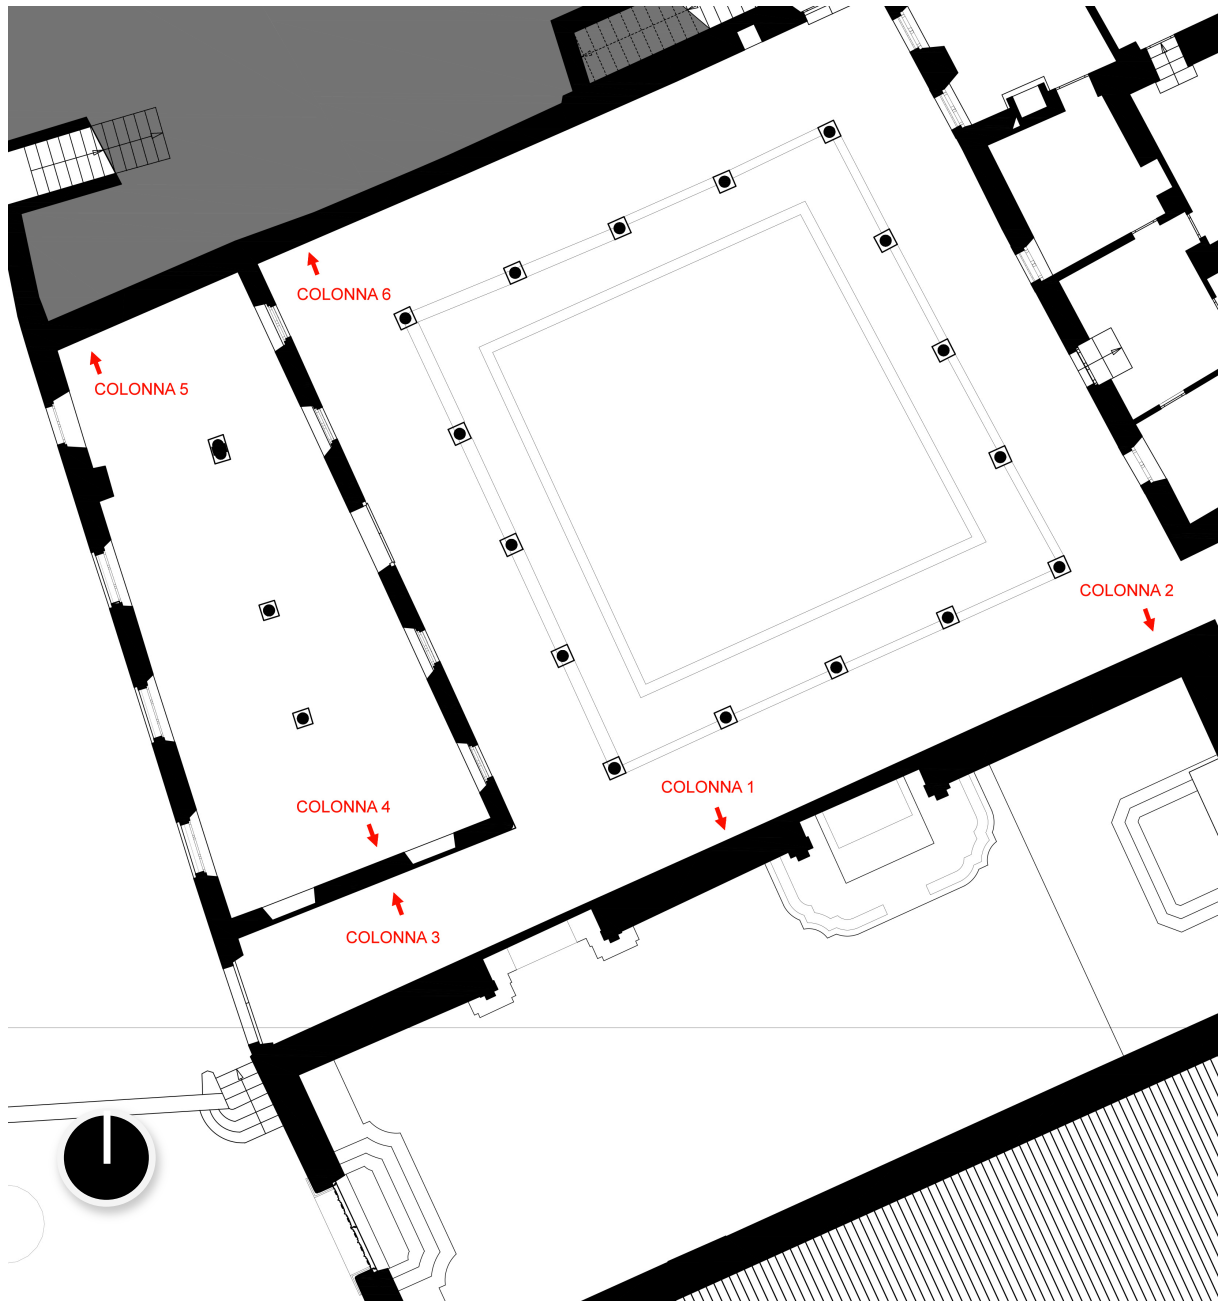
Stralcio planimetrico con indicazione dei rilievi (drilling) effettuati
